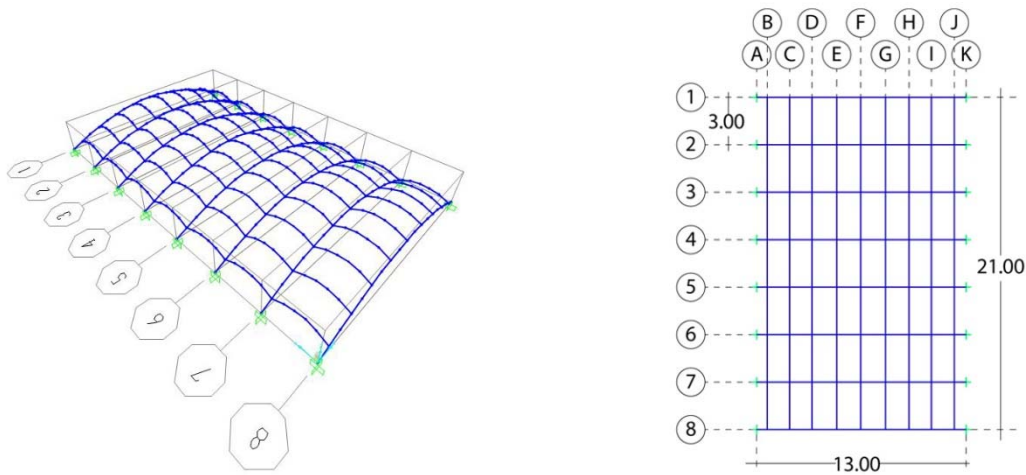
Perspectiva (izquierda), Planta (derecha)
